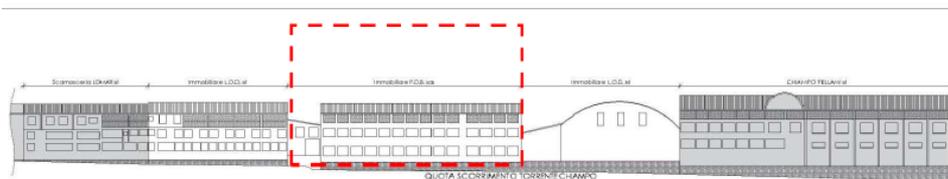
Prospetto da sud (in rosso edificio FDB Sas) (Arch. Sara Anna Forte)
